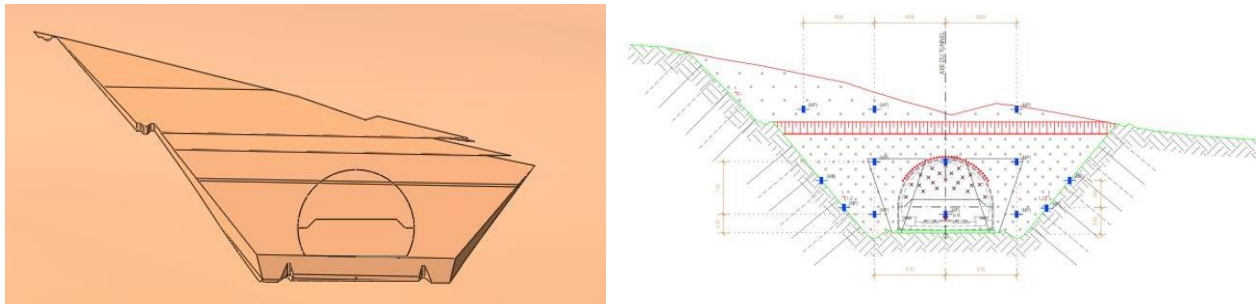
Comparaison entre l'entrée du tunnel sur le plan et l'entrée obtenue par MIDAS GTS.
